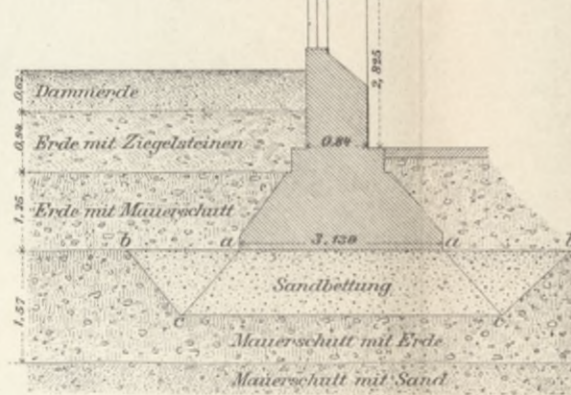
Königl. Regierungs-Gebäude zu Breslau. M. 1:125.
